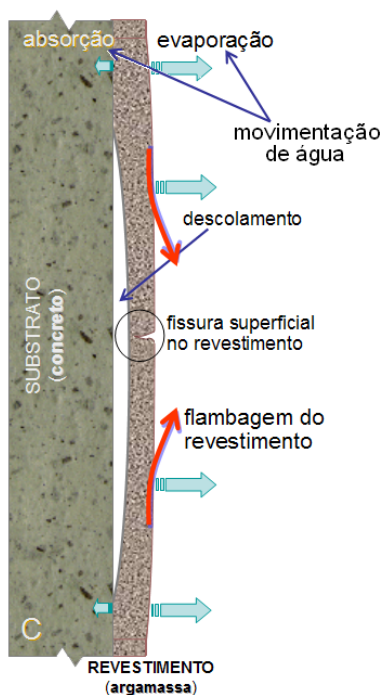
Ilustração do descolamento a aparecimento de fissuras no revestimento de argamassa (adaptada de Carasek et al., 2005).
